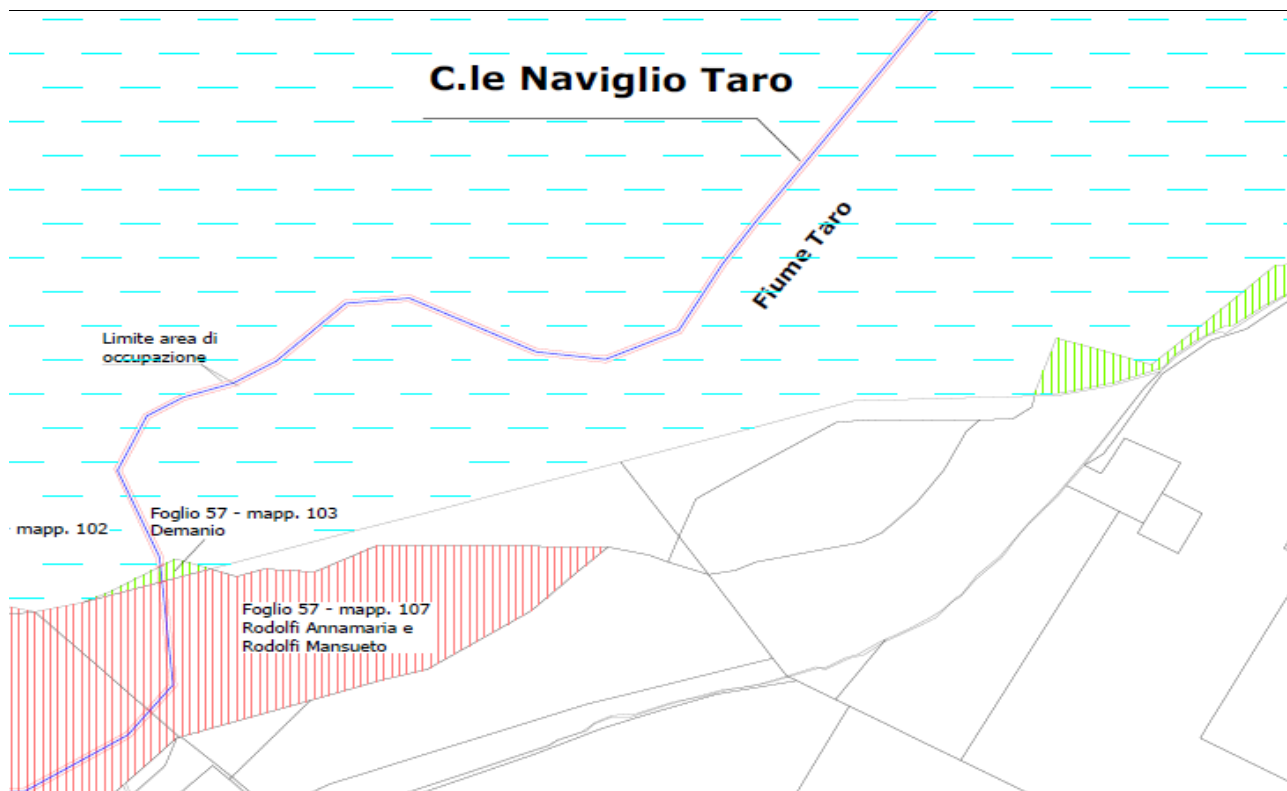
Posizione del canale Naviglio Taro rispetto area d'interesse
